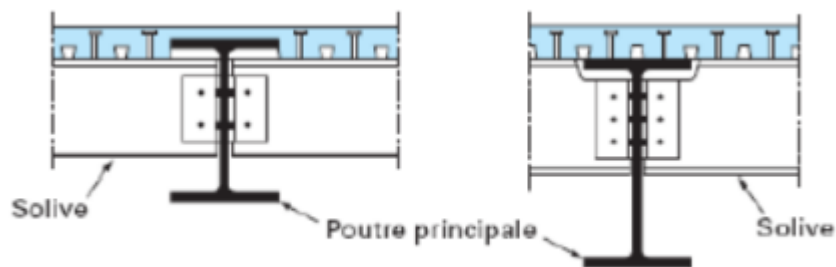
assemblage de type poutre-poutre de plancher mixte
